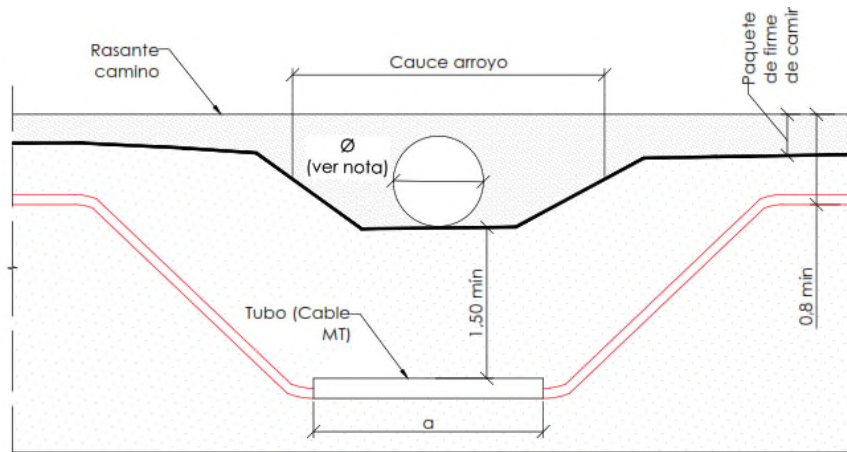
Sección de paso enterrado de cables en cruce con Arroyo y camino. Cruce tipo 1
